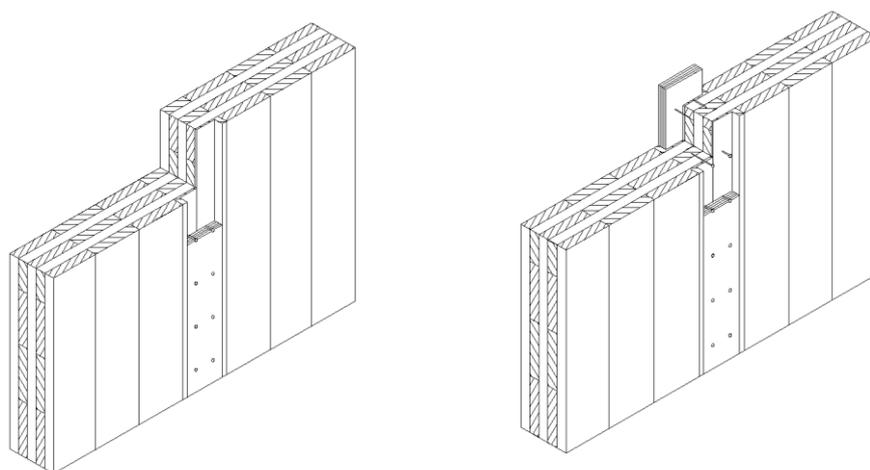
Collegamento parete-parete XLAM: giunto con tavole coprigiunto in compensato
